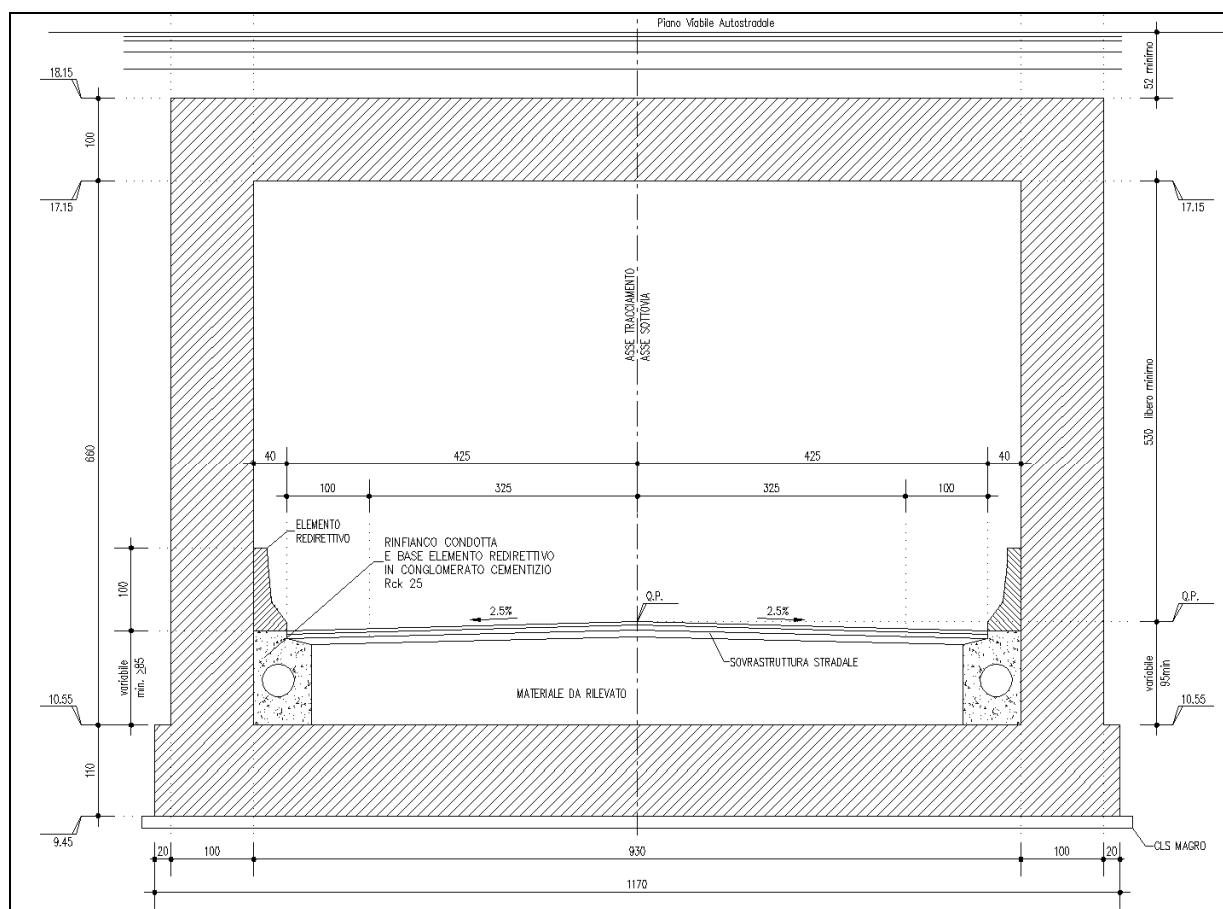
SEZIONE TRASVERSALE DEL SOTTOVIA
